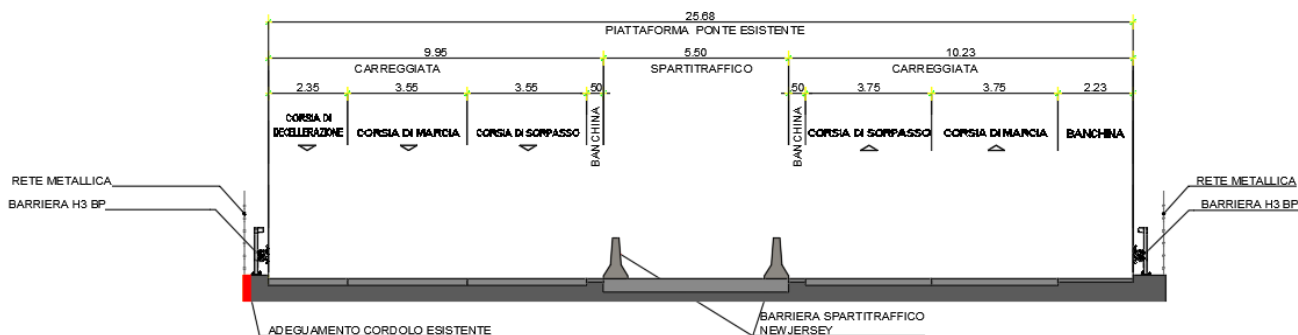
Sezione tipologica viadotto oggetto della progettazione
